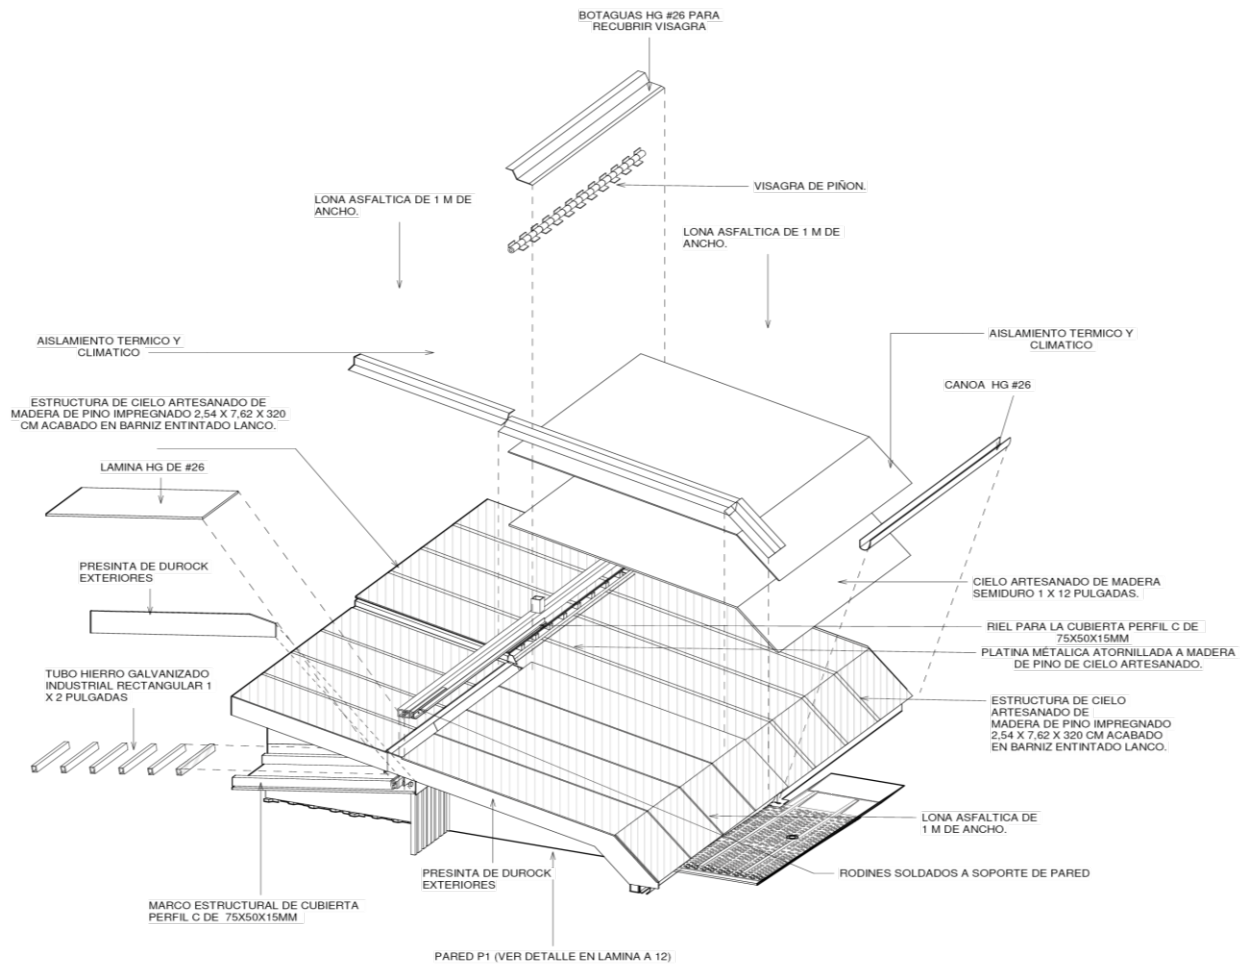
Detalles Explotados de Cubiertas. Elaboración Propia.
